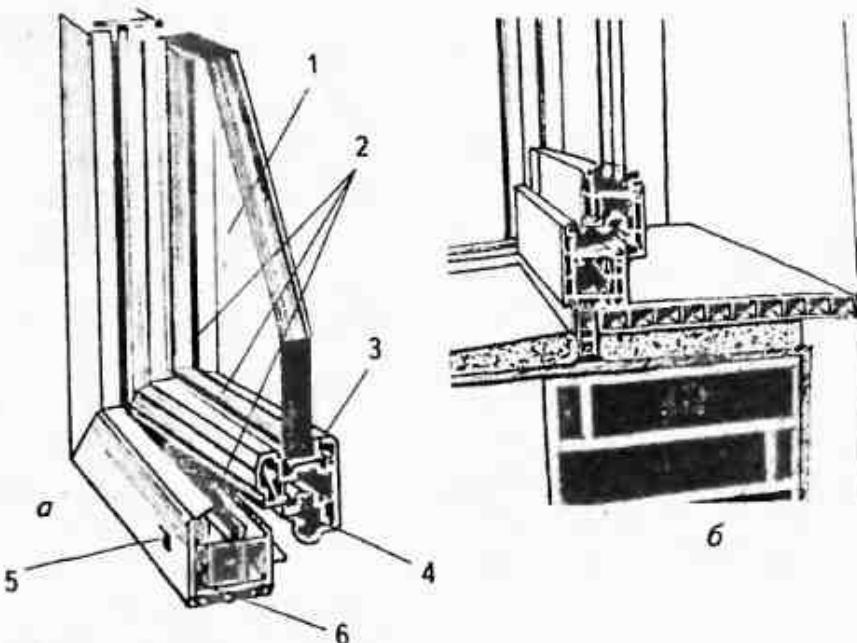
Составляющие окна: а — окно из трехкамерного ПВХ-профиля; 1 — стеклопакет; 2 — уплотнители; 3 — штапик; 4 — паз для фурнитуры; 5 — дренажная заглушка; 6 — усилительный вкладыш; б — схема установки окна из трехкамерного ПВХ-профиля и пластмассового подоконника на кирпичной стене
